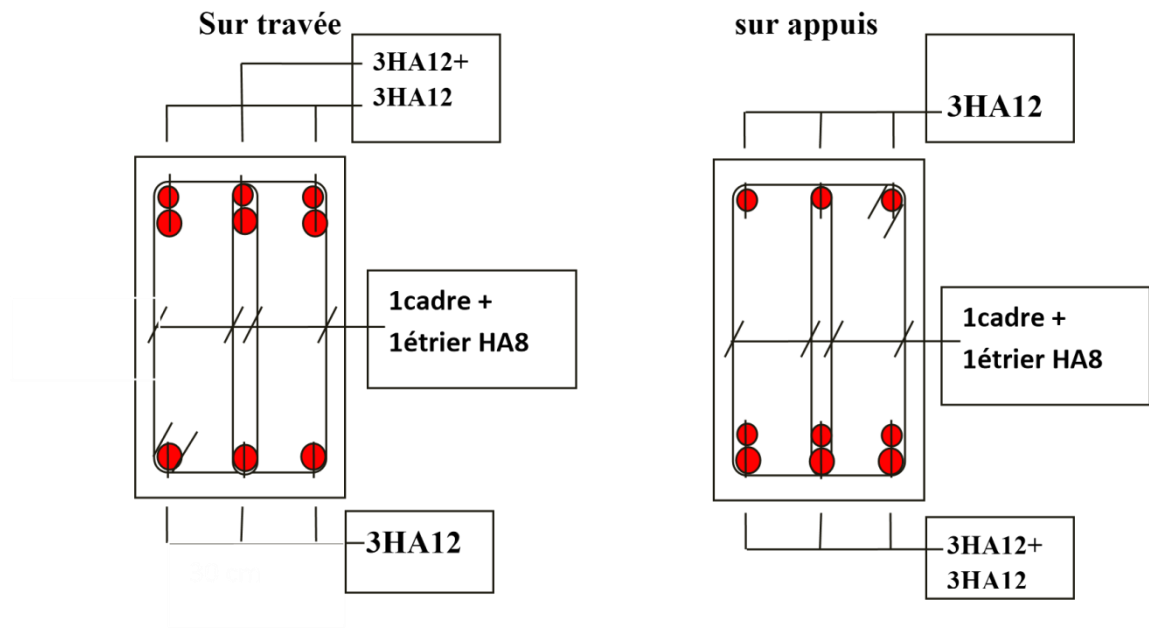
Schéma de ferrailage de poutre de redressement.
